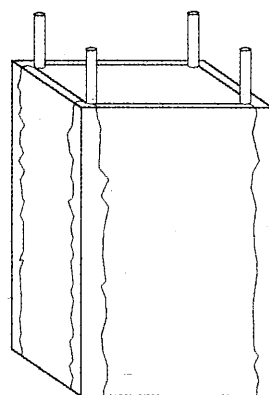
Fisuración provocada por la oxidación y corrosión de las armaduras.
